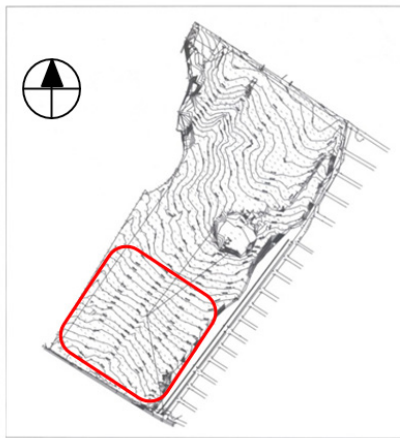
Plano de ubicación del terreno, Puertas de Rolón.
